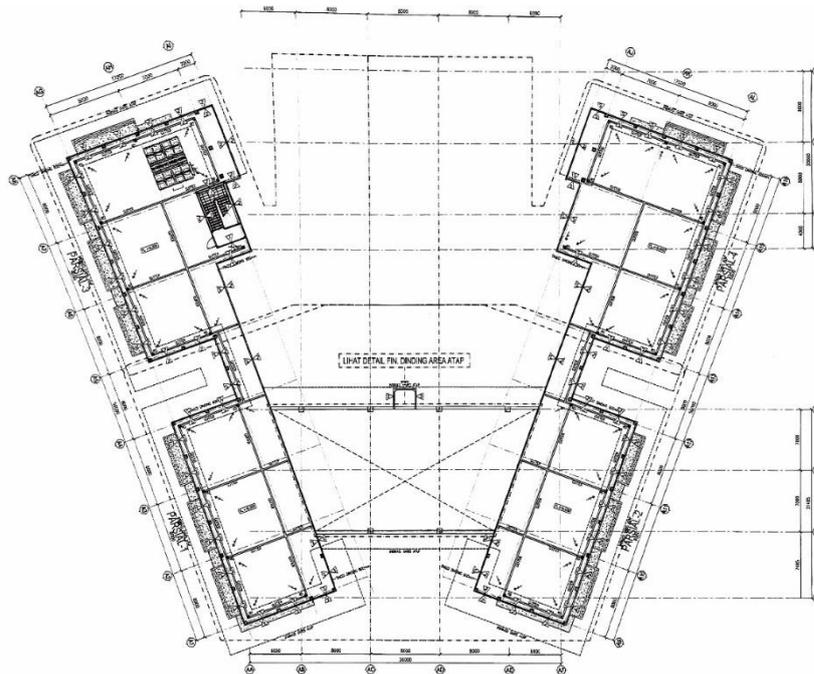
Denah rencana *finishing* dinding lantai 2
